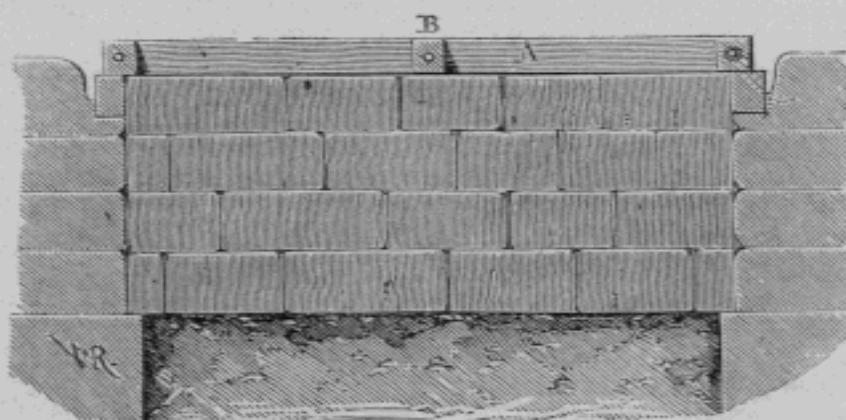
Coupe d'une fosse surmontée d'un plancher à claire-voie.
